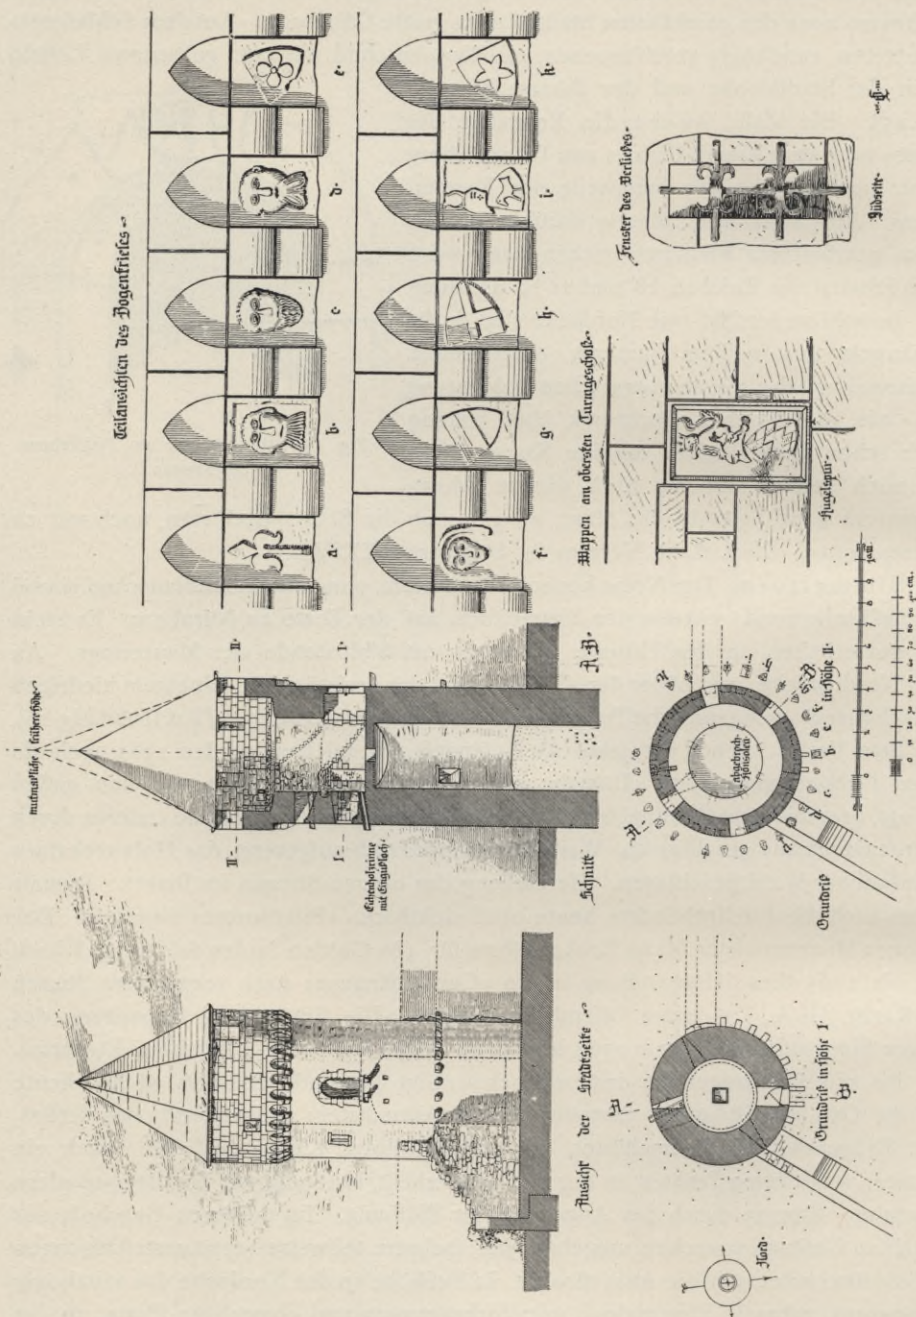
Der Simmelturm zu Bretten. Grundrisse, Schnitte und Teilsichten.
